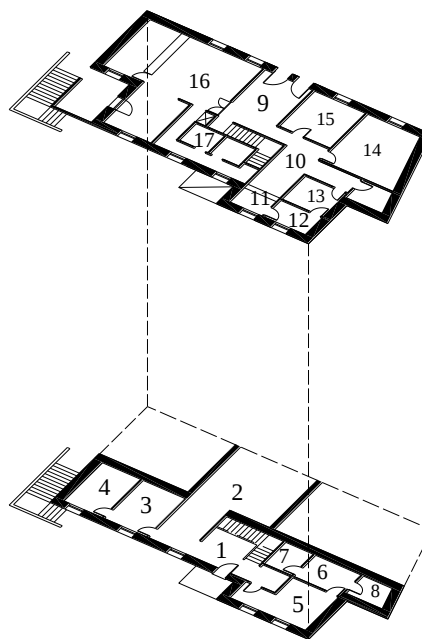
| Planta esquemática do Piso Térreo e Piso -1, Residência dos Governadores.
